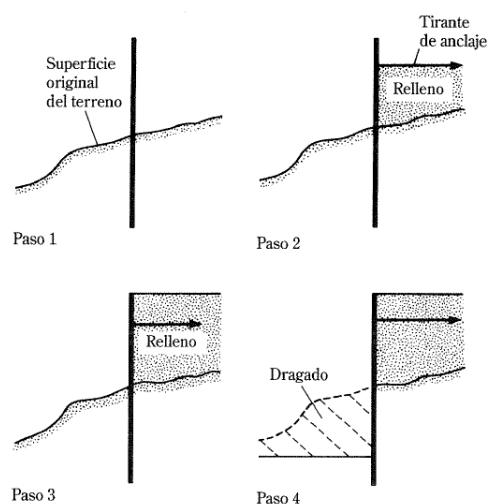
Secuencia constructiva de una tablestaca con suelo excavado
